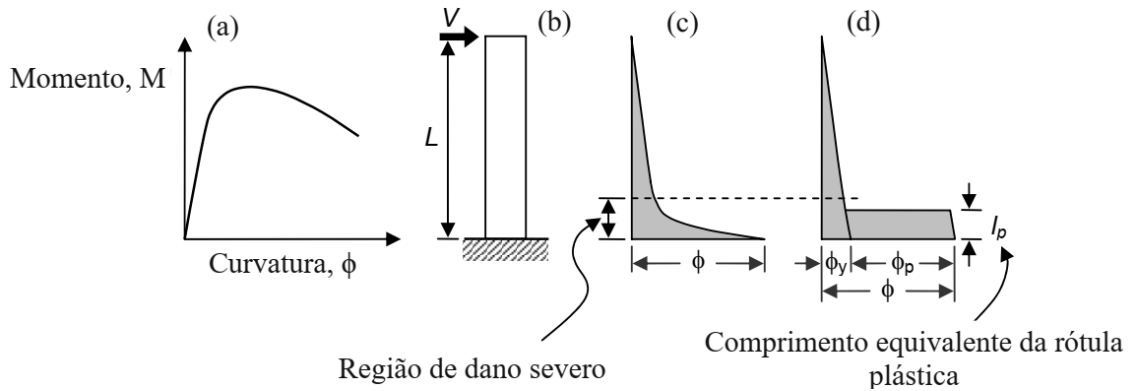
Definição de rótula plástica (Fonte: Priestley e Park)
